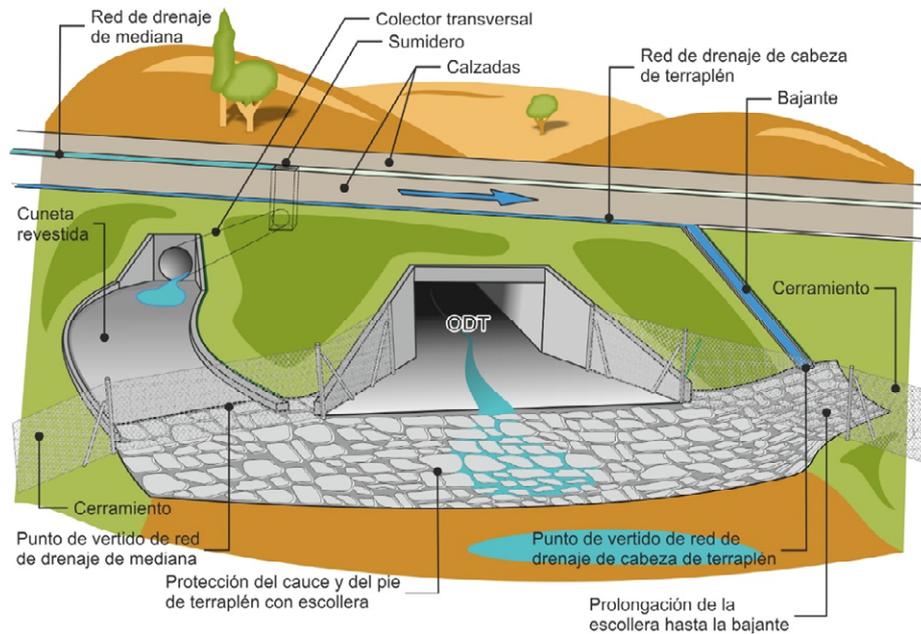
EJEMPLO DE DESAGÜE A LA SALIDA DE UNA OBRA DE DRENAGE TRANSVERSAL
